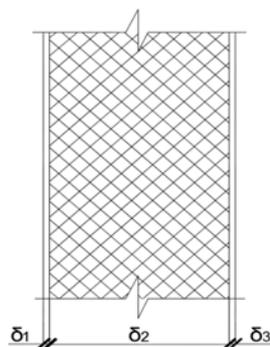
Расчетная схема стеновой ограждающей конструкции
